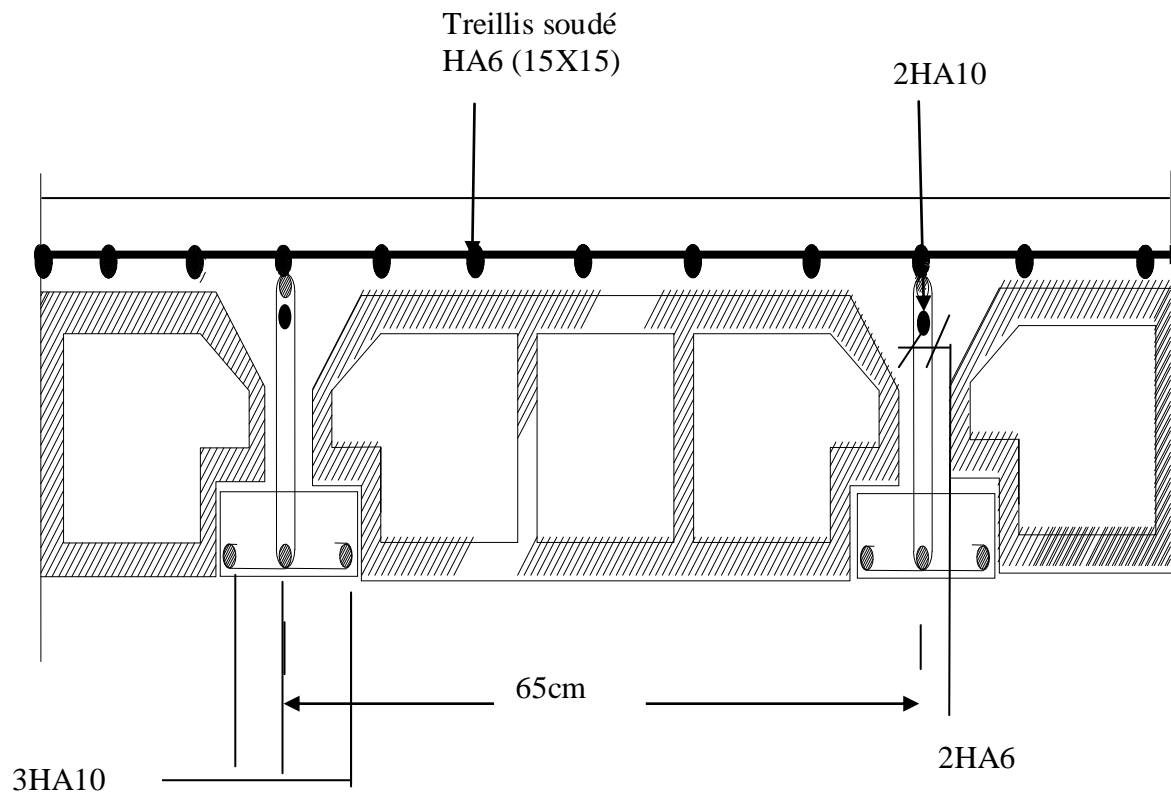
Plan de ferrailage du plancher en corps creux.
